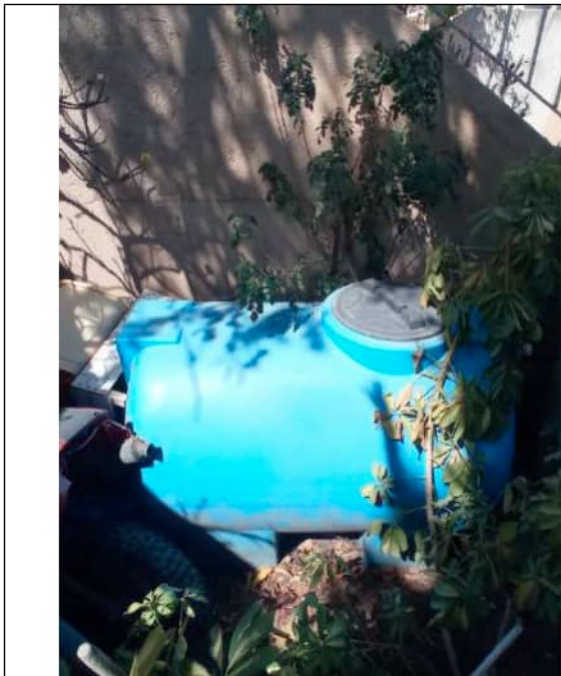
Particolare del serbatoio di accumulo dell'impianto autoclave
